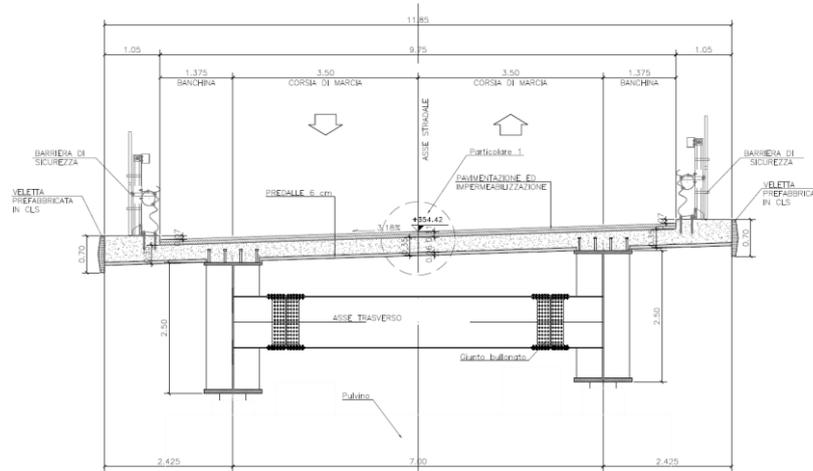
Sezione Trasversale dell'impalcato del Viadotto Marroggia 1.
